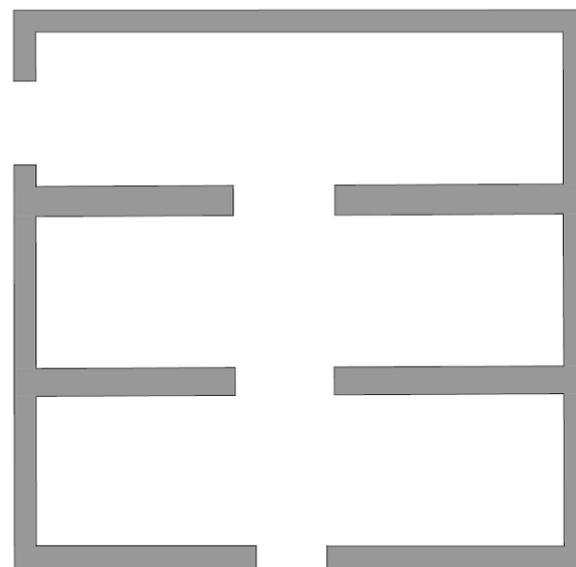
Esquema de la planta de la Alquería. 2014. Fuente: elaboración propia.
